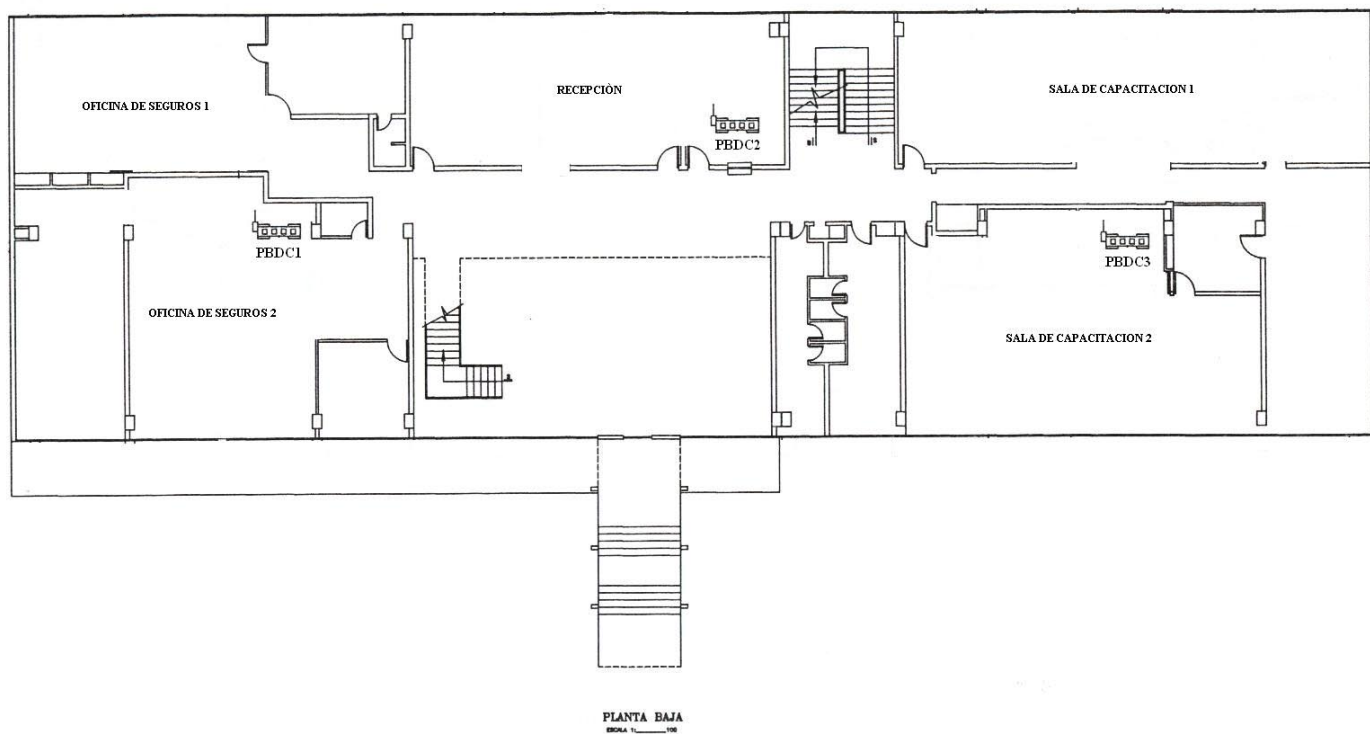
Distribución de dispositivos inalámbricos UWB en la Planta Baja
